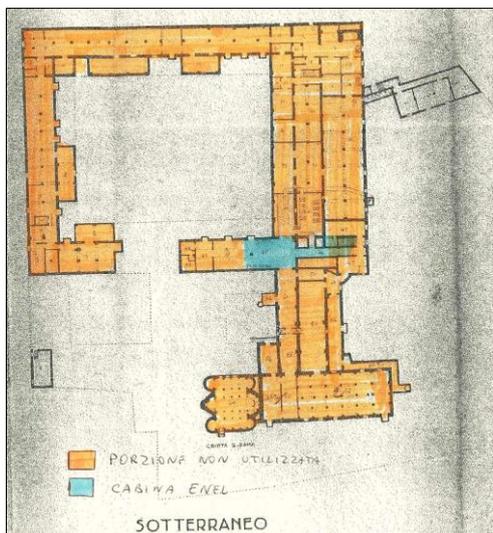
Min. Difesa - *Inventario* – Planimetria del piano interrato (1939-1944)
